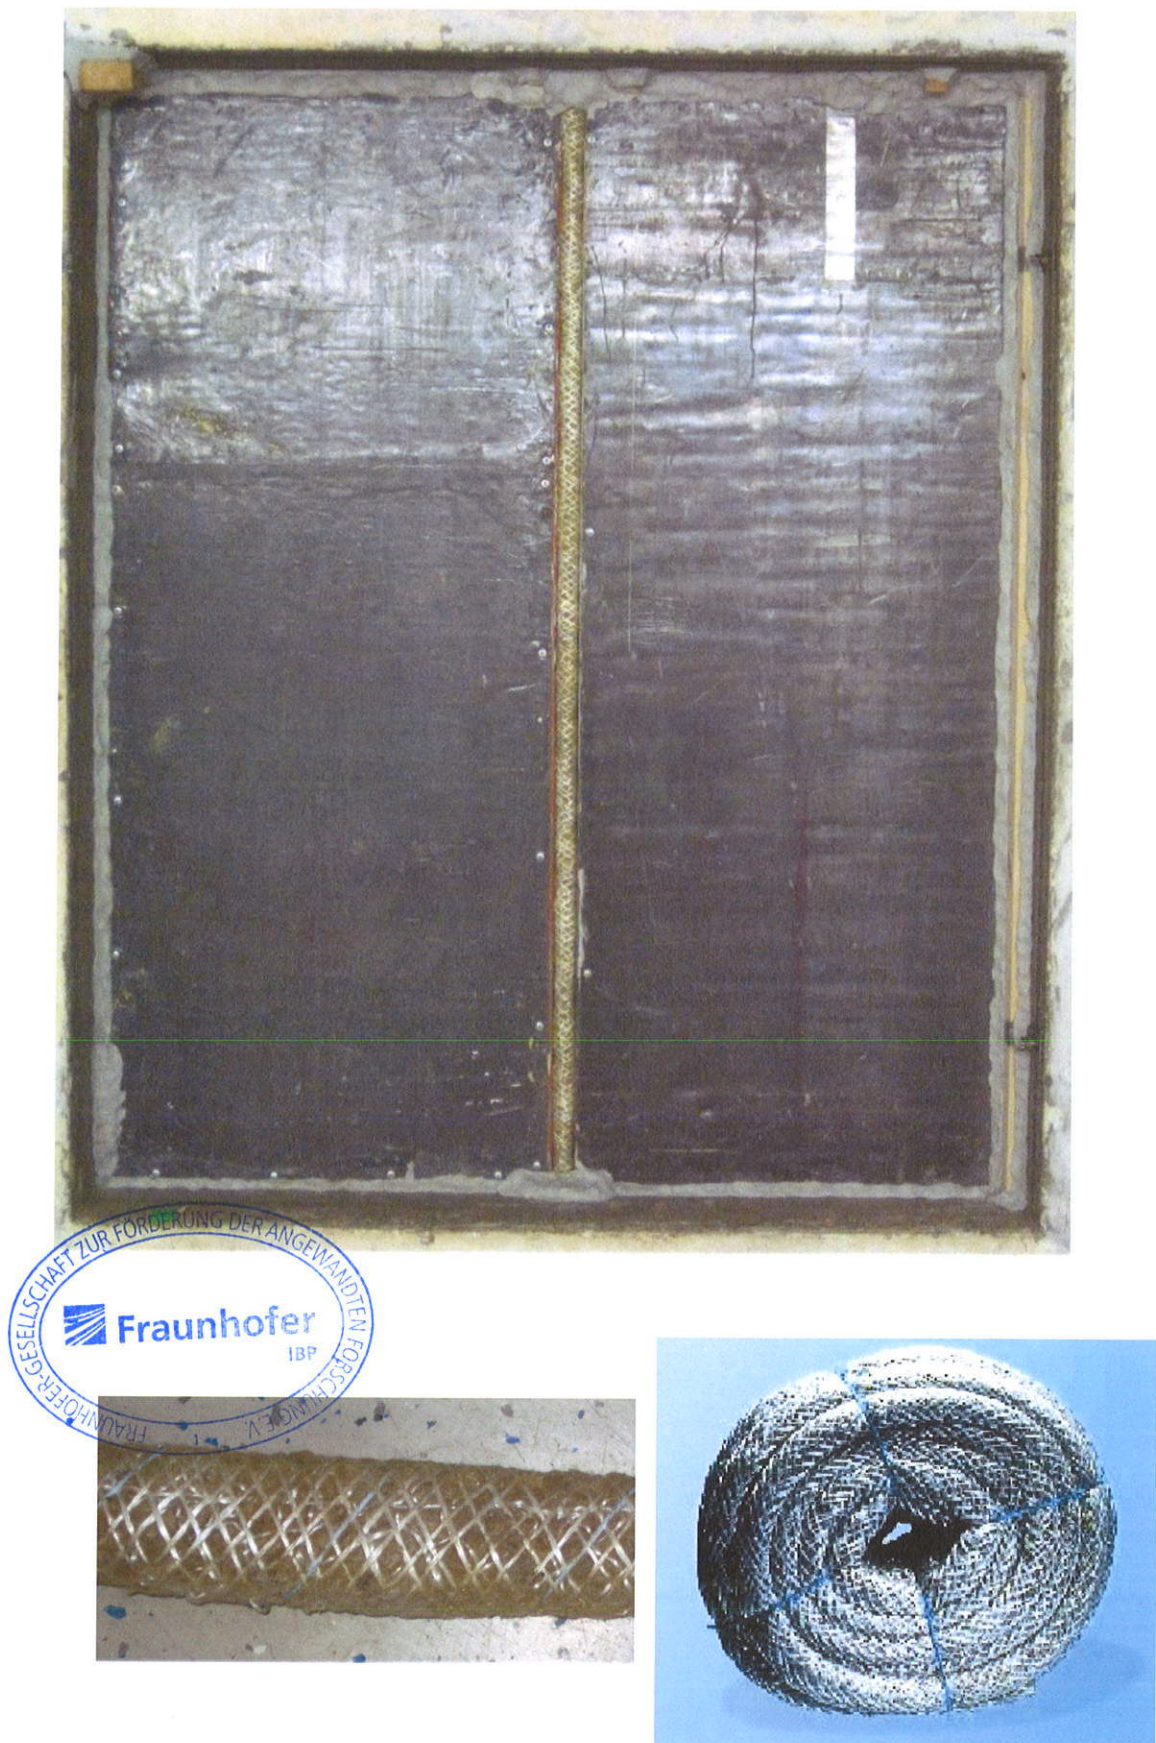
Abbildungen des Prüfobjekts (oben: eingebaut im Prüfstand; unten: Detailabbildungen).
